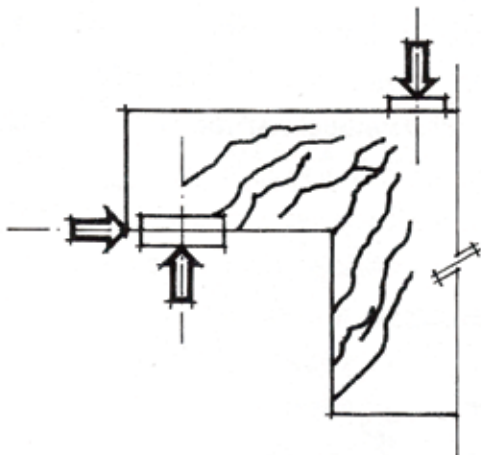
Ejemplo: patrón típico de agrietamiento en apoyo. [11]
